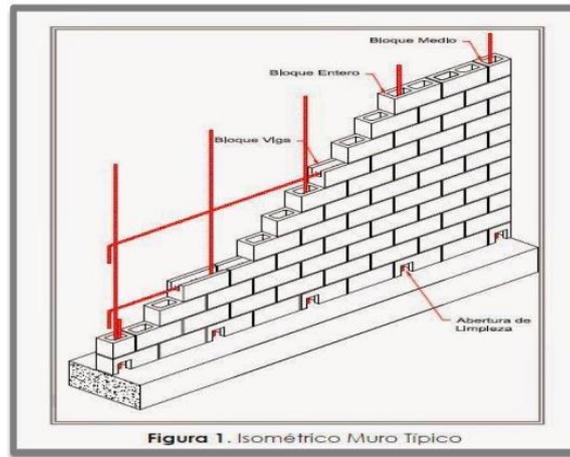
Albañilería Armada – Fuente: Ecured⁹
